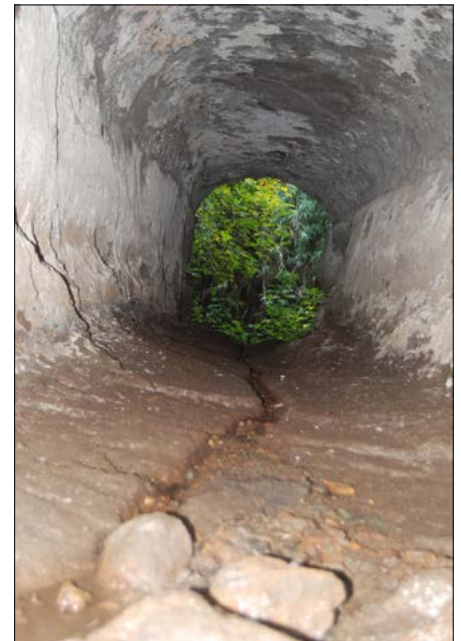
Cerveteri, Fosso del Manganello: tunnel di drenaggio presso la Via degli Inferi (Foto V. Bellelli)
